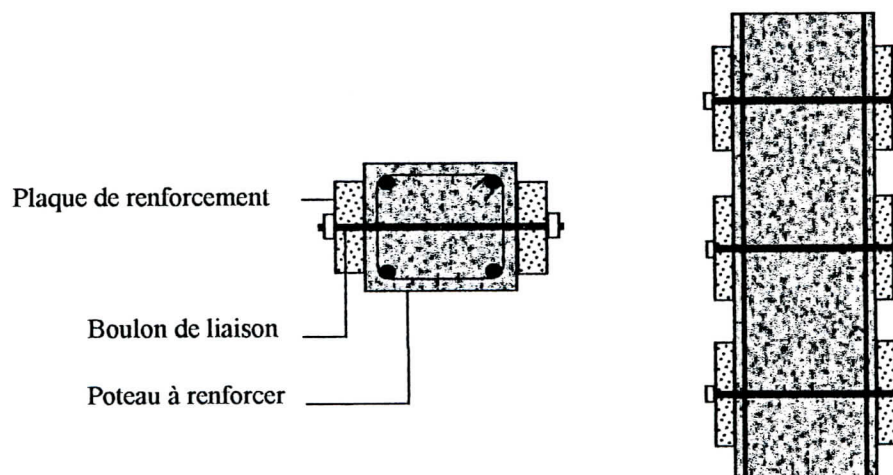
Renforcement des poteaux par des organes de liaison [13]
